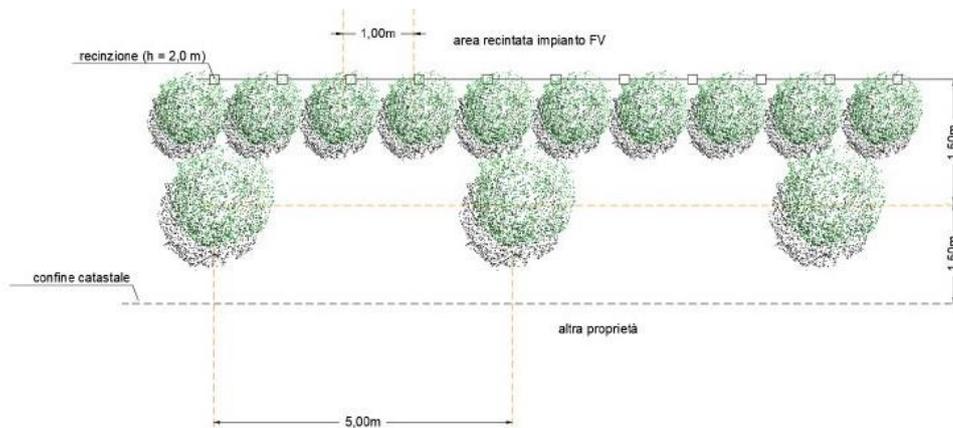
Siepe polispecifica (planimetria di progetto) – siepe e filare di olivo.
